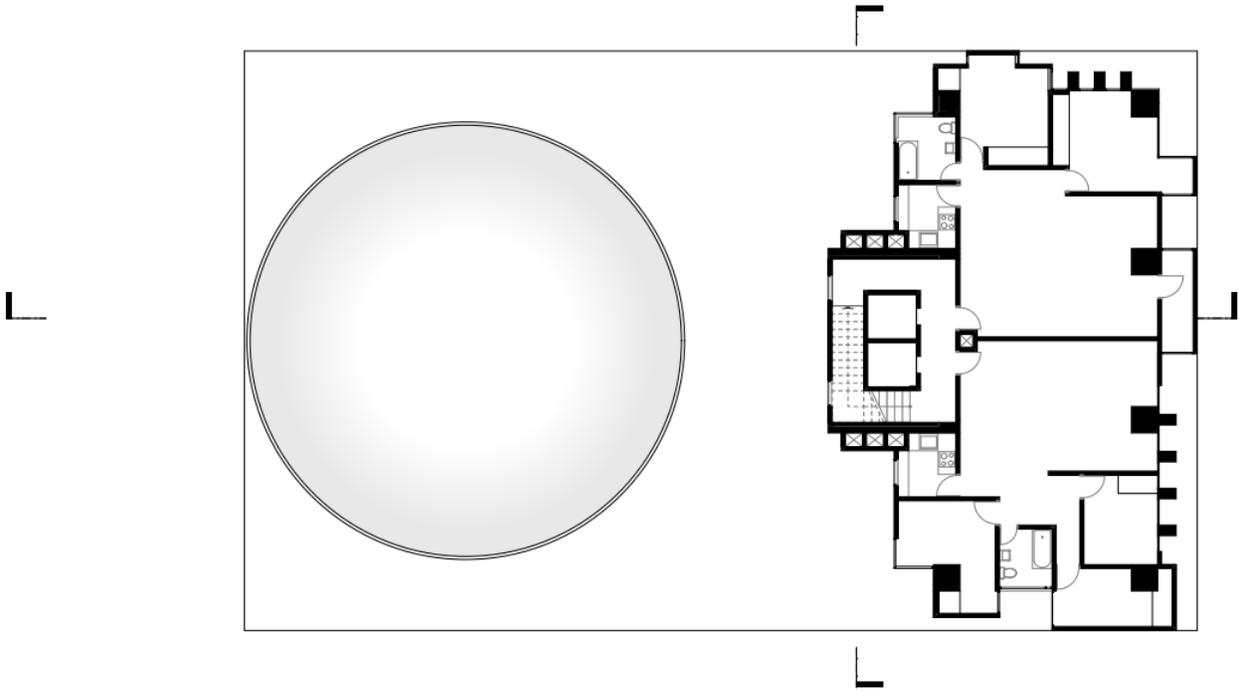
Planta alta planificada N+33.50. Fuente: Tesistas.
